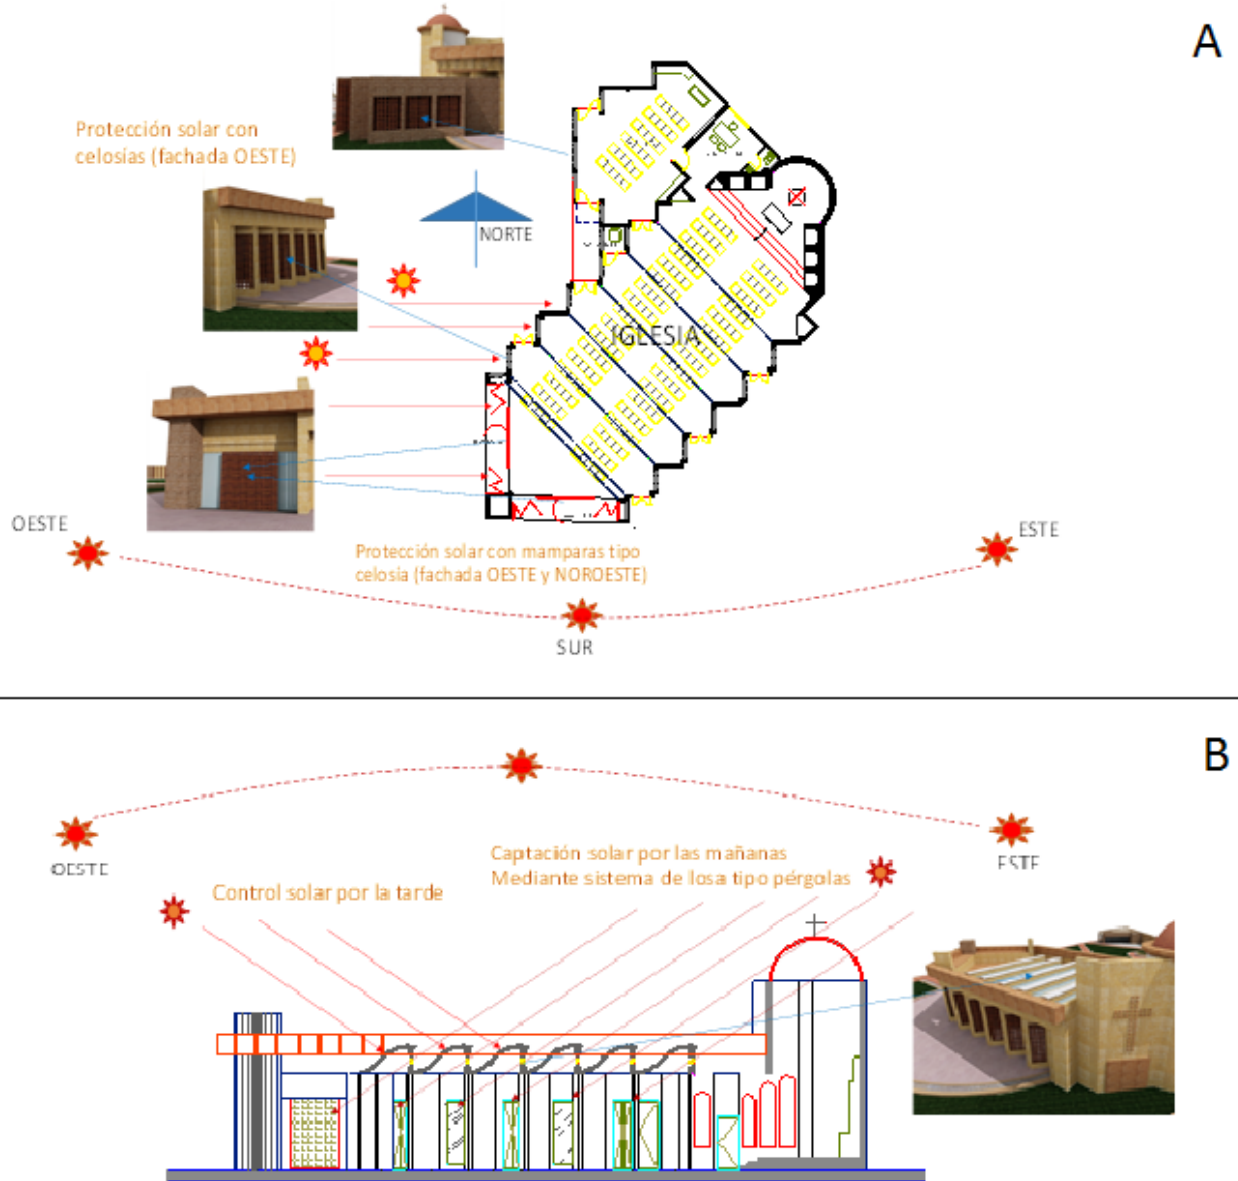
A) Planta arquitectónica del área de la iglesia, B) Sección transversal área de la iglesia.
